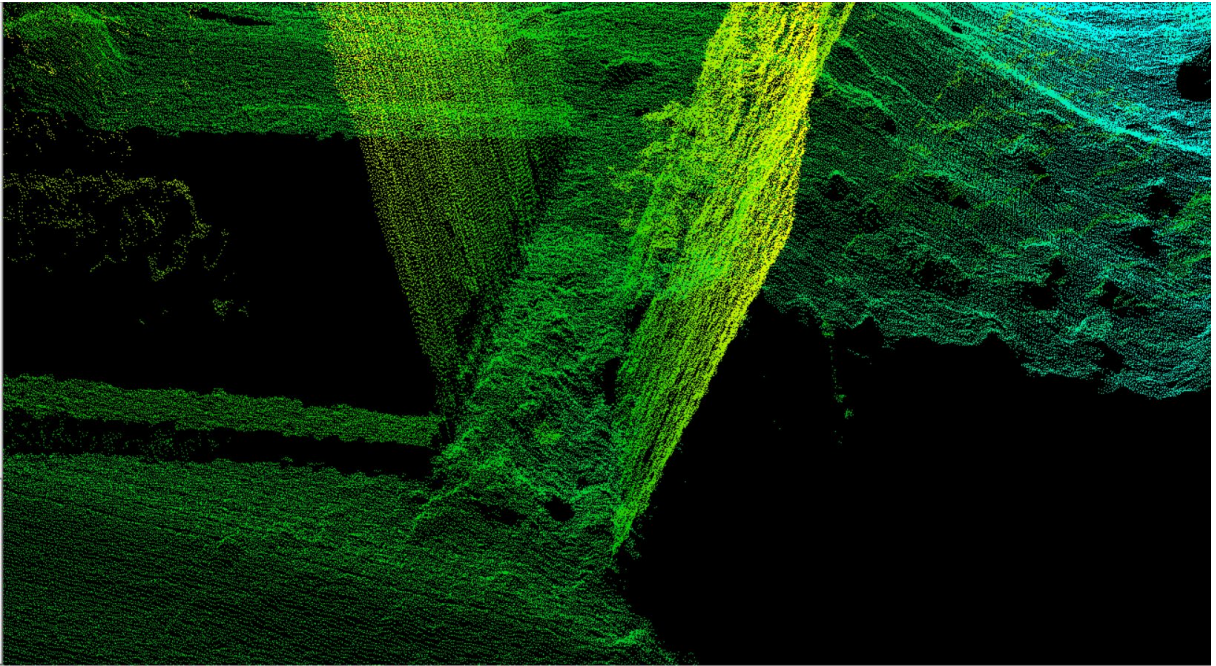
Superestructura pila P6 colapsada junto a cimentación y paramento frontal pila P9.
